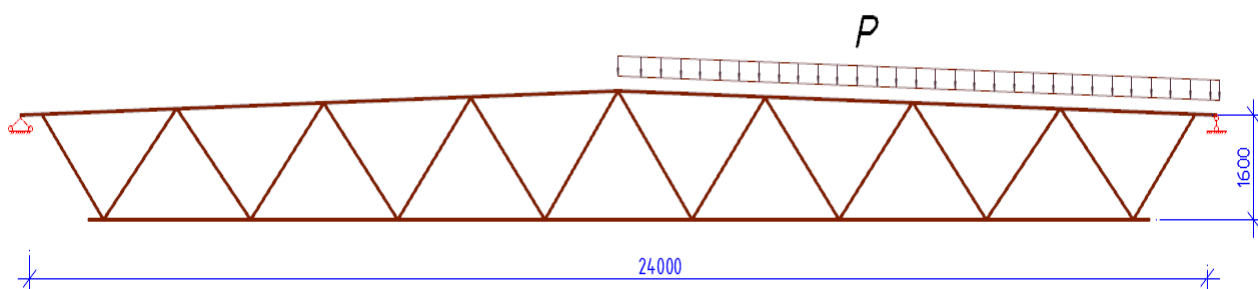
Схема загрузки стропильной фермы снеговой нагрузкой справа
